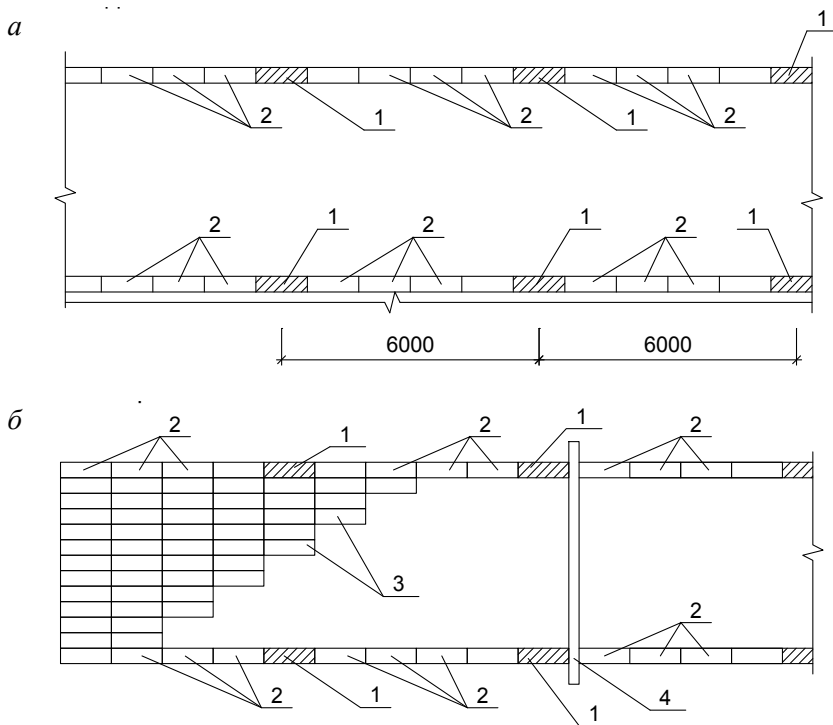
Последовательность укладки плитного утеплителя на захватке:
